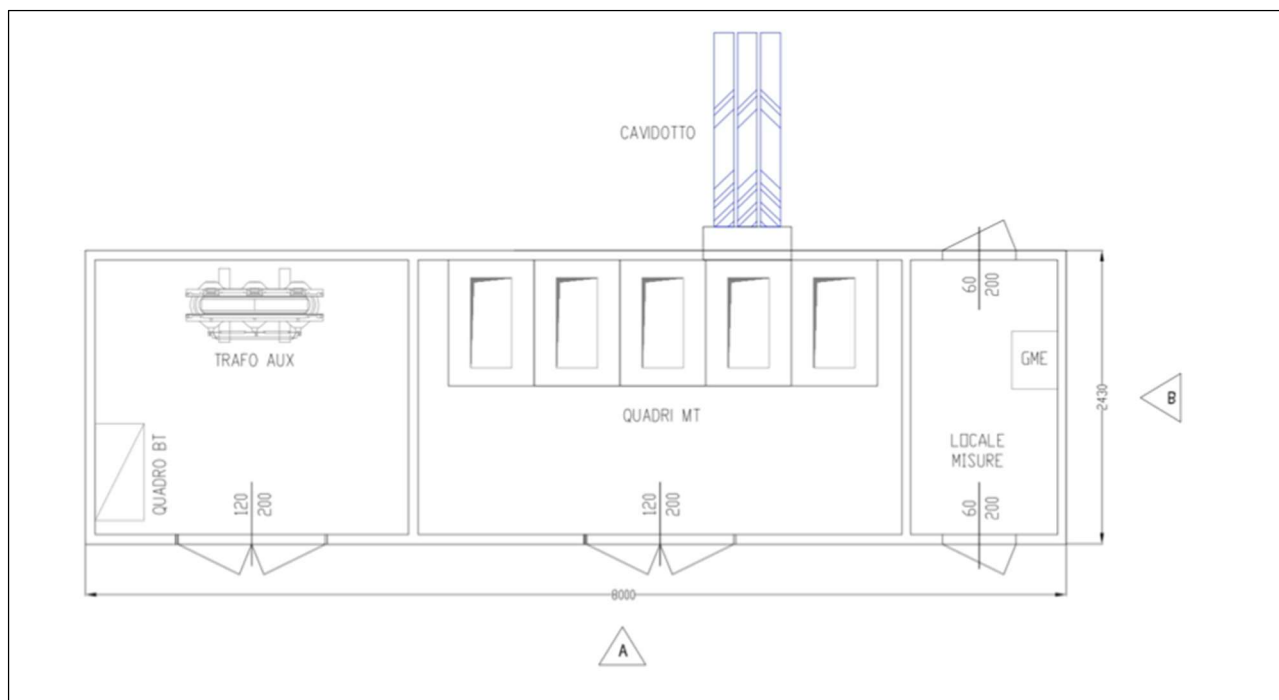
Locale cabina di Parallelo MT- Prospetto
